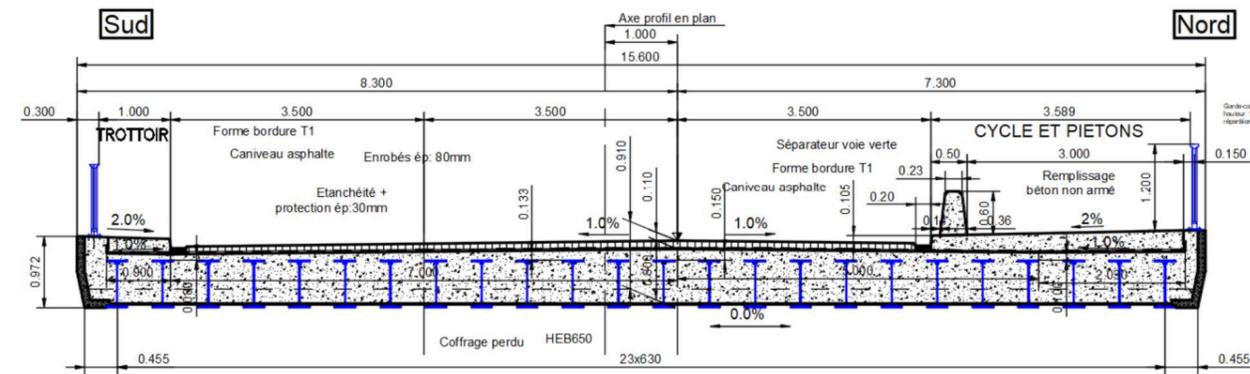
Coupe transversale du futur OA Eglise Rouge (AVP)
